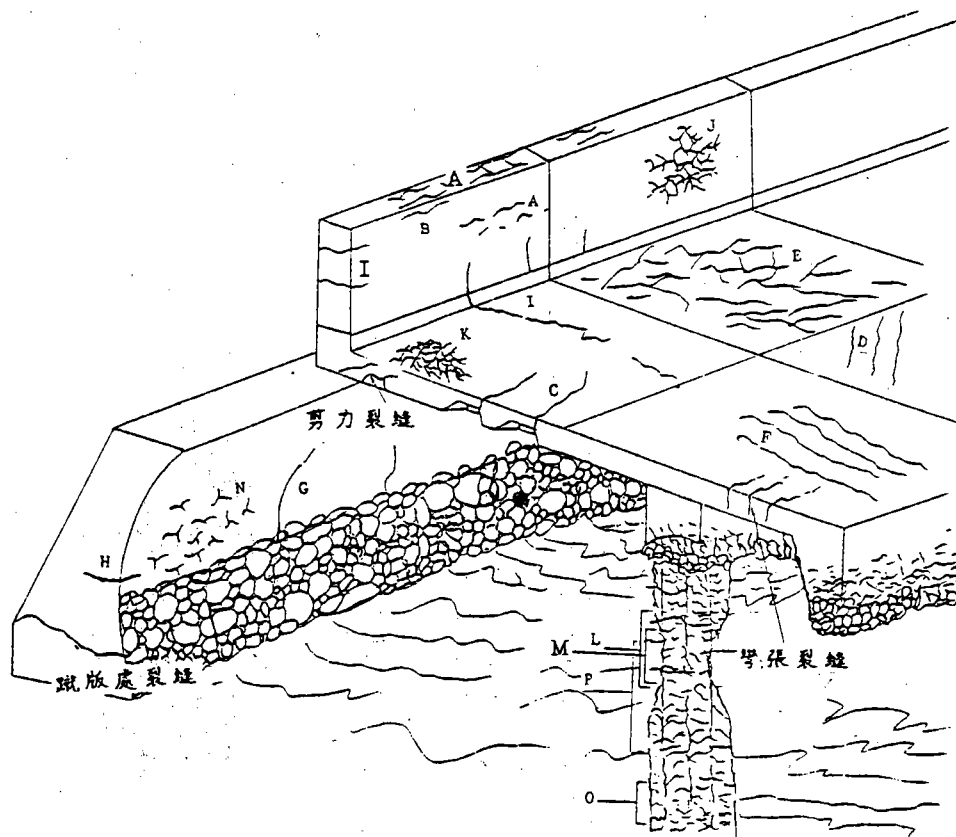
混凝土非結構性裂紋之歸類
